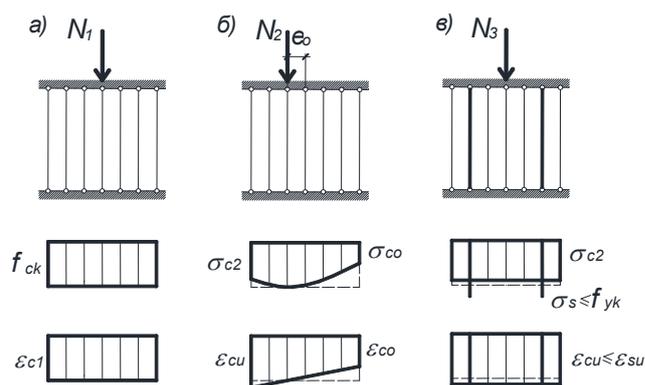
К перераспределению напряжений между отдельными фибрами сжатых бетонных и железобетонных элементов
